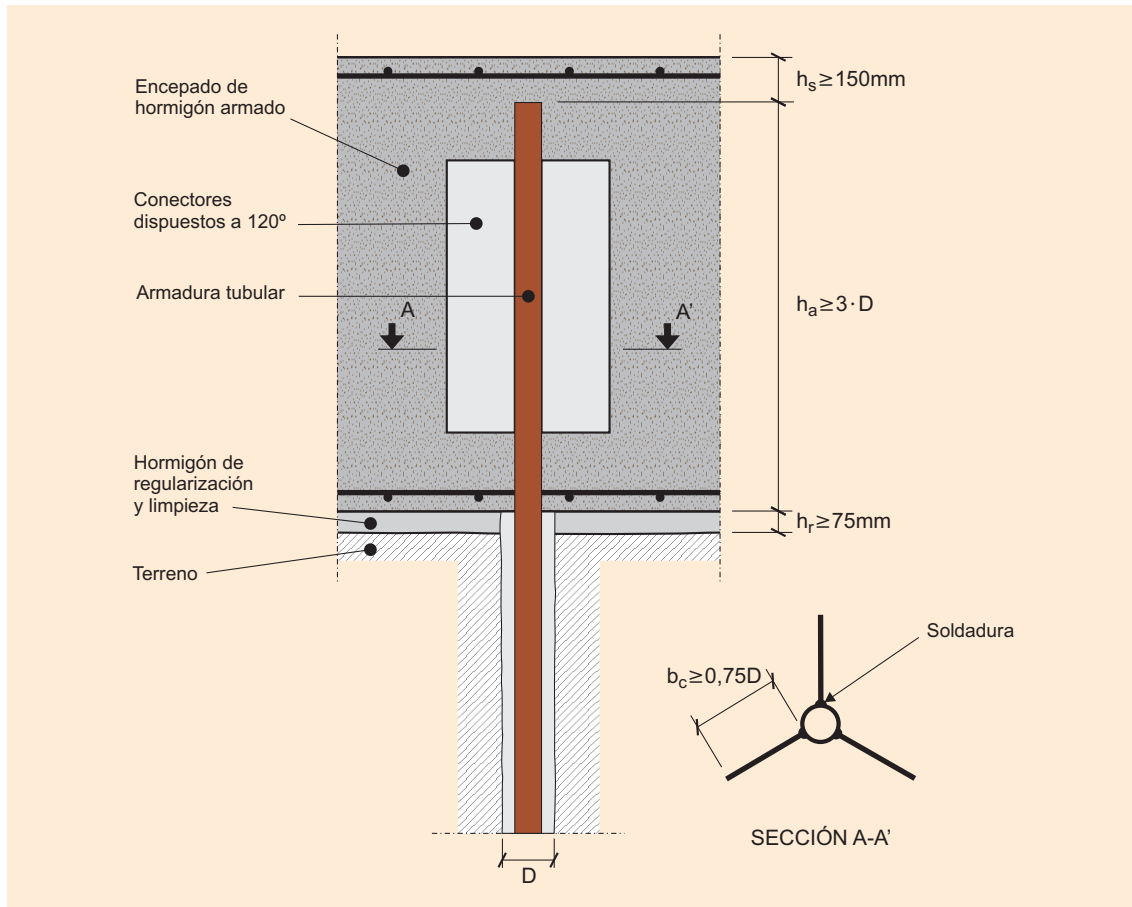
EJEMPLO DE CONEXIÓN CON CHAPAS SOLDADAS LONGITUDINALMENTE
